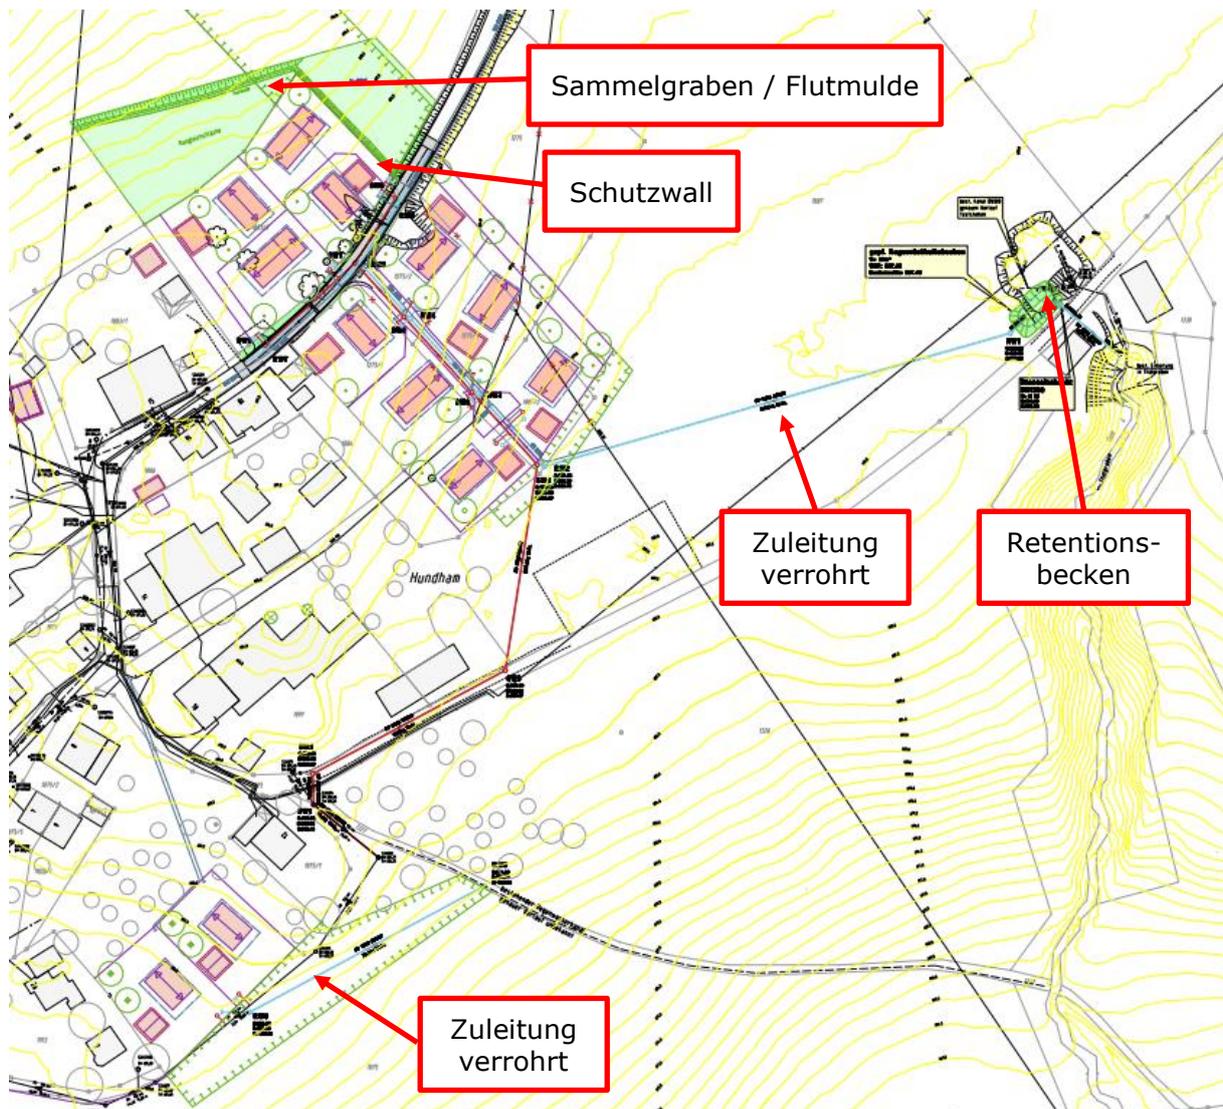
Auszug aus Lageplan zur Erschließung Baugebiet OT Hundham, Stand März 2020
